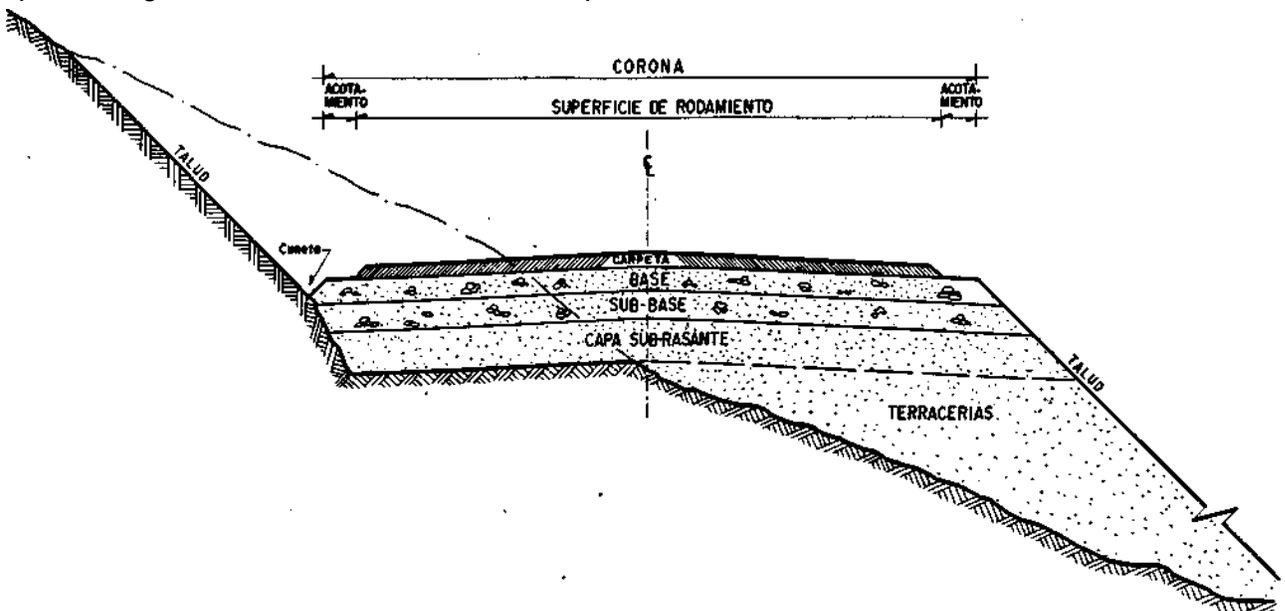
Sección transversal típica de un pavimento flexible en una sección en balcón.
